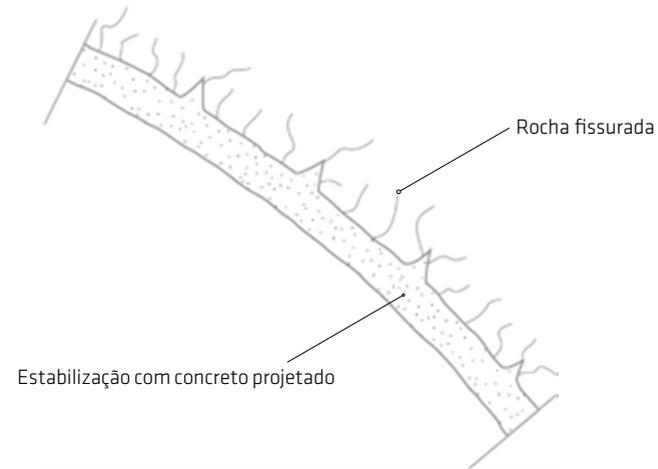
Estabilização pelo preenchimento de fissuras do substrato e pela construção de arco de concreto projetado e a rocha circundante
